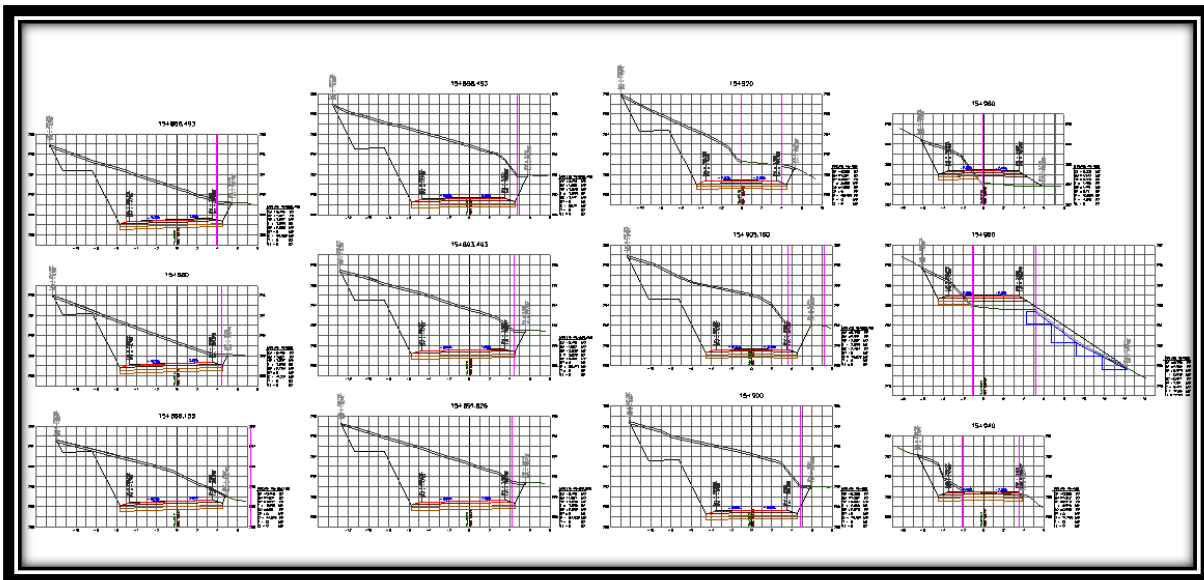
Secciones de construcción del km 15+866.153 al km 15+980.000.
